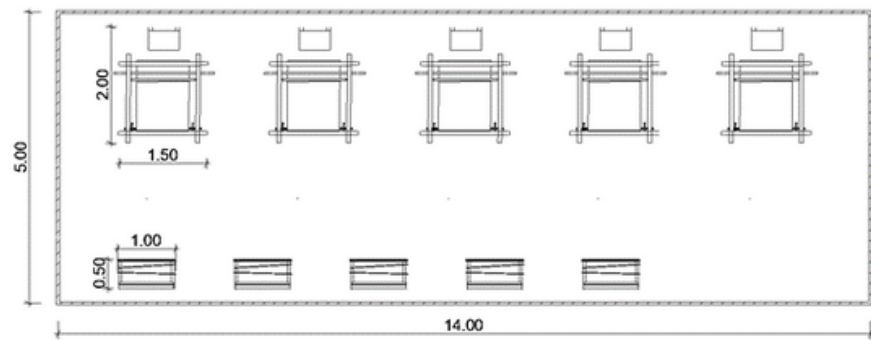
Transformasi Denah Ruang Pameran 3
